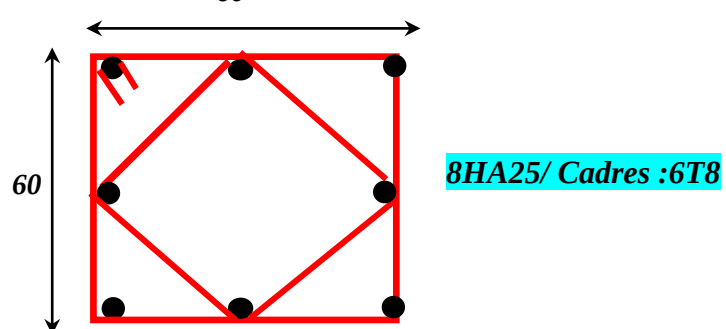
Schéma de ferrailage des poteaux 60×60.
